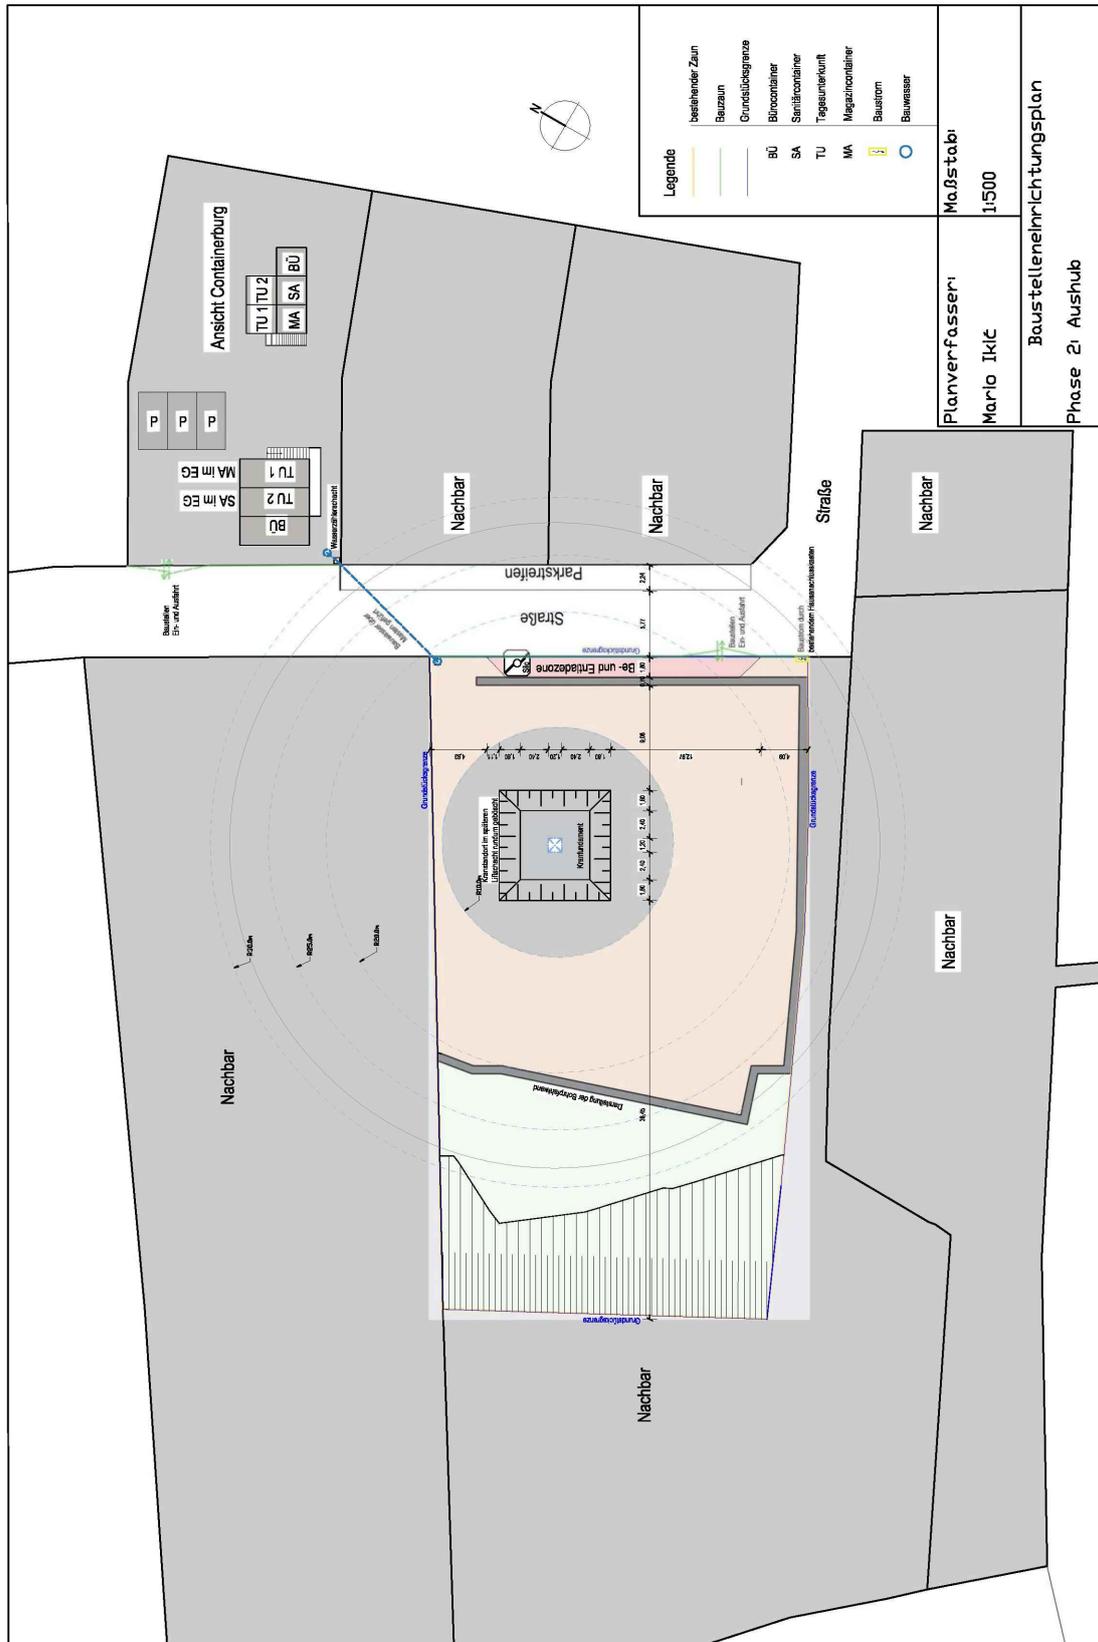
Baustelleneinrichtungsplan für Bauphase 2
